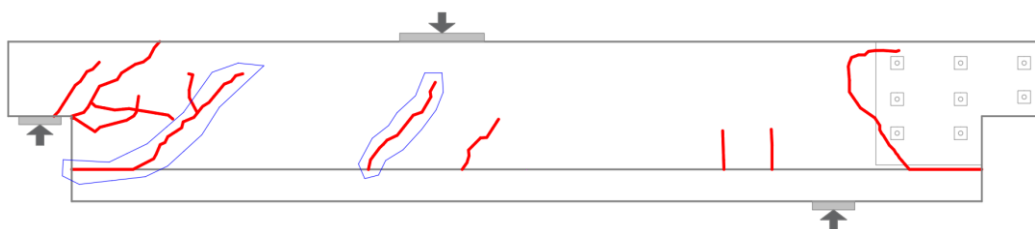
Quadro fessurativo sperimentale, trave A, schema statico 2, termine prova [2]
